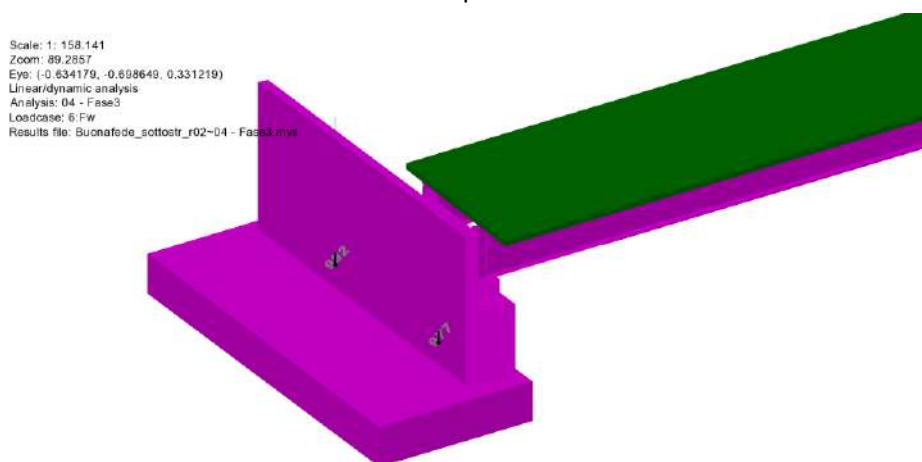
Elementi per la verifica del muro frontale della spalle
